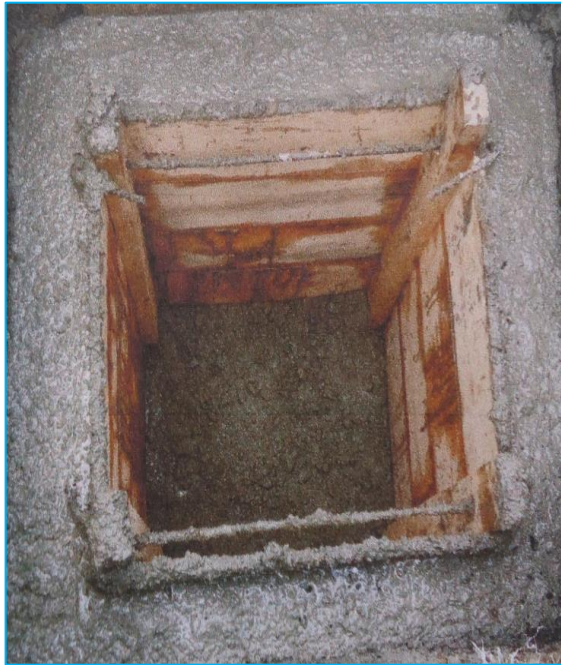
30 Construcción cajillas - instalaciones domiciliarias Alcantarillado pluvial
